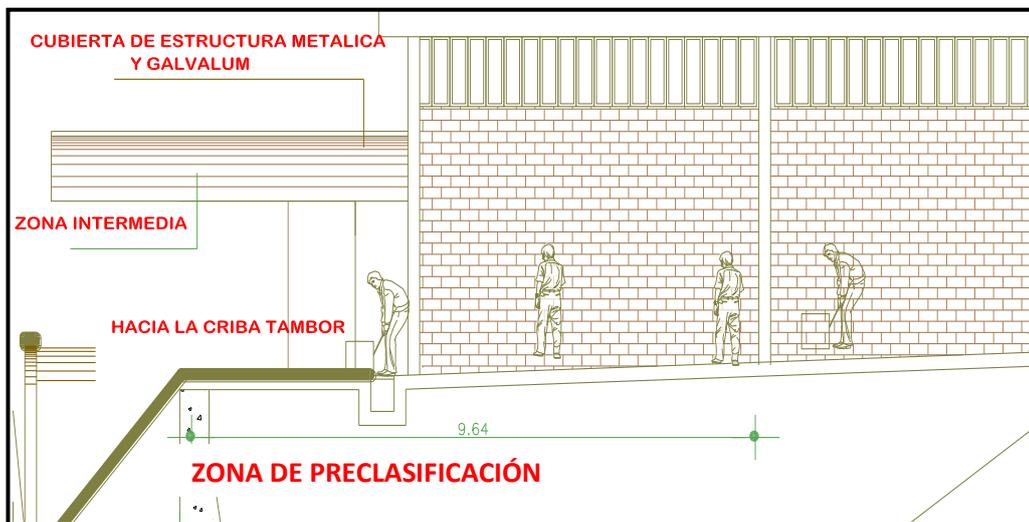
Vista arquitectónica zona de pre clasificación planta de reciclaje
